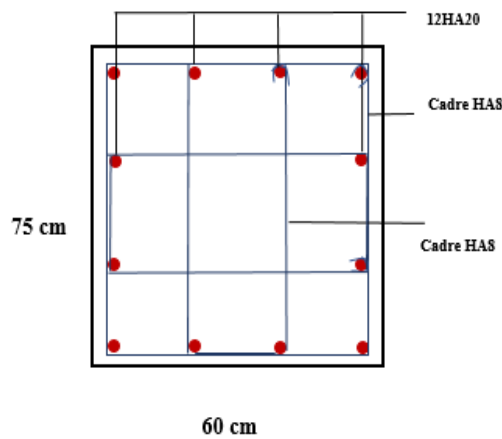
Schéma des Ferraillages des poteaux 60×75.
